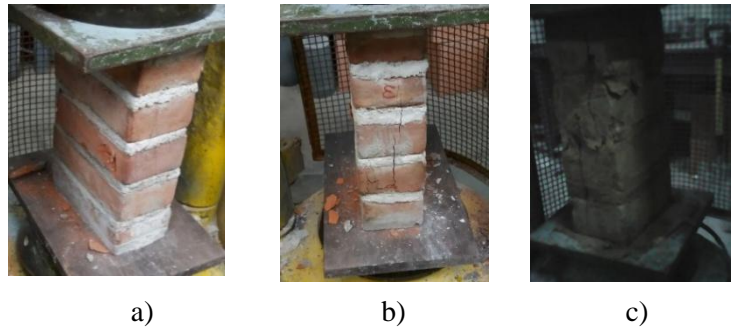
(a) Prisma de albañilería de adobe artesanal cocido, (b) Vista de la grieta en el momento de falla del prisma al aplicarle la máxima carga de compresión.,(c) Falla o rotura del prisma hecho de adobe convencional crudo.
